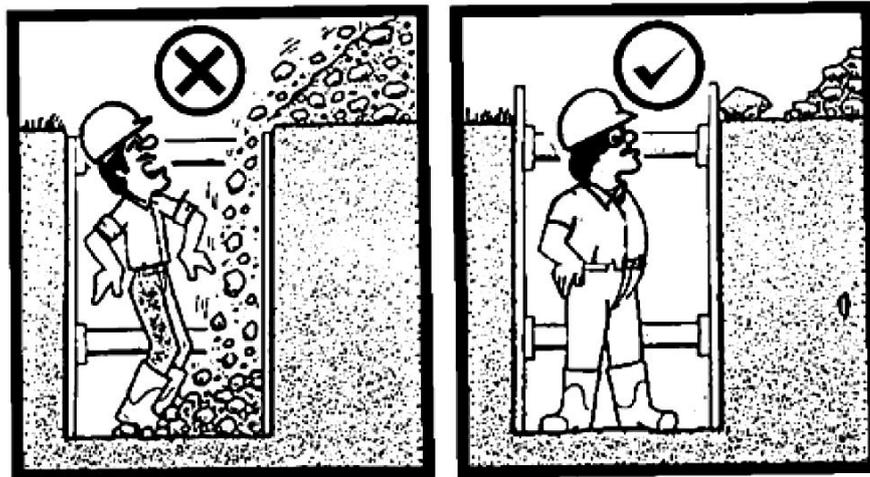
Método de protección en las excavaciones Fuente: Construcción Auto gestionada – Ministerio de Trabajo y Seguridad Social – SENA
